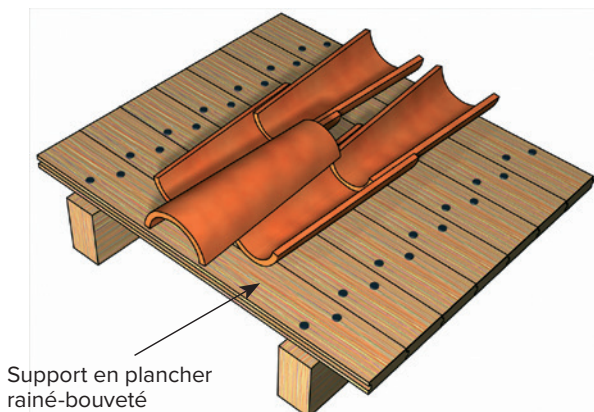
Pose des tuiles canal de terre cuite sur support en plancher rainé-bouveté
